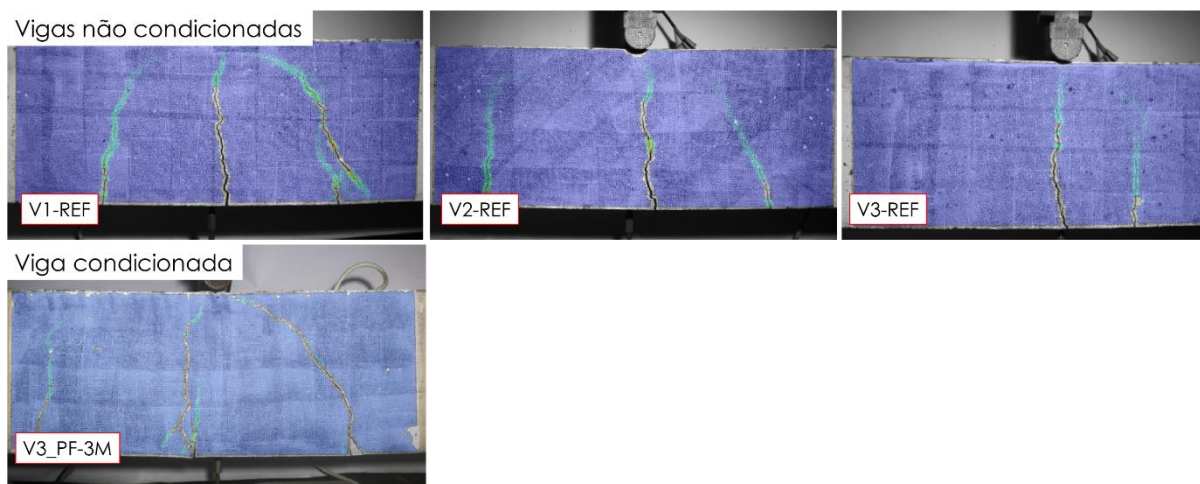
Comparação da fissuração das vigas na ruptura – vigas pré-fissuras
